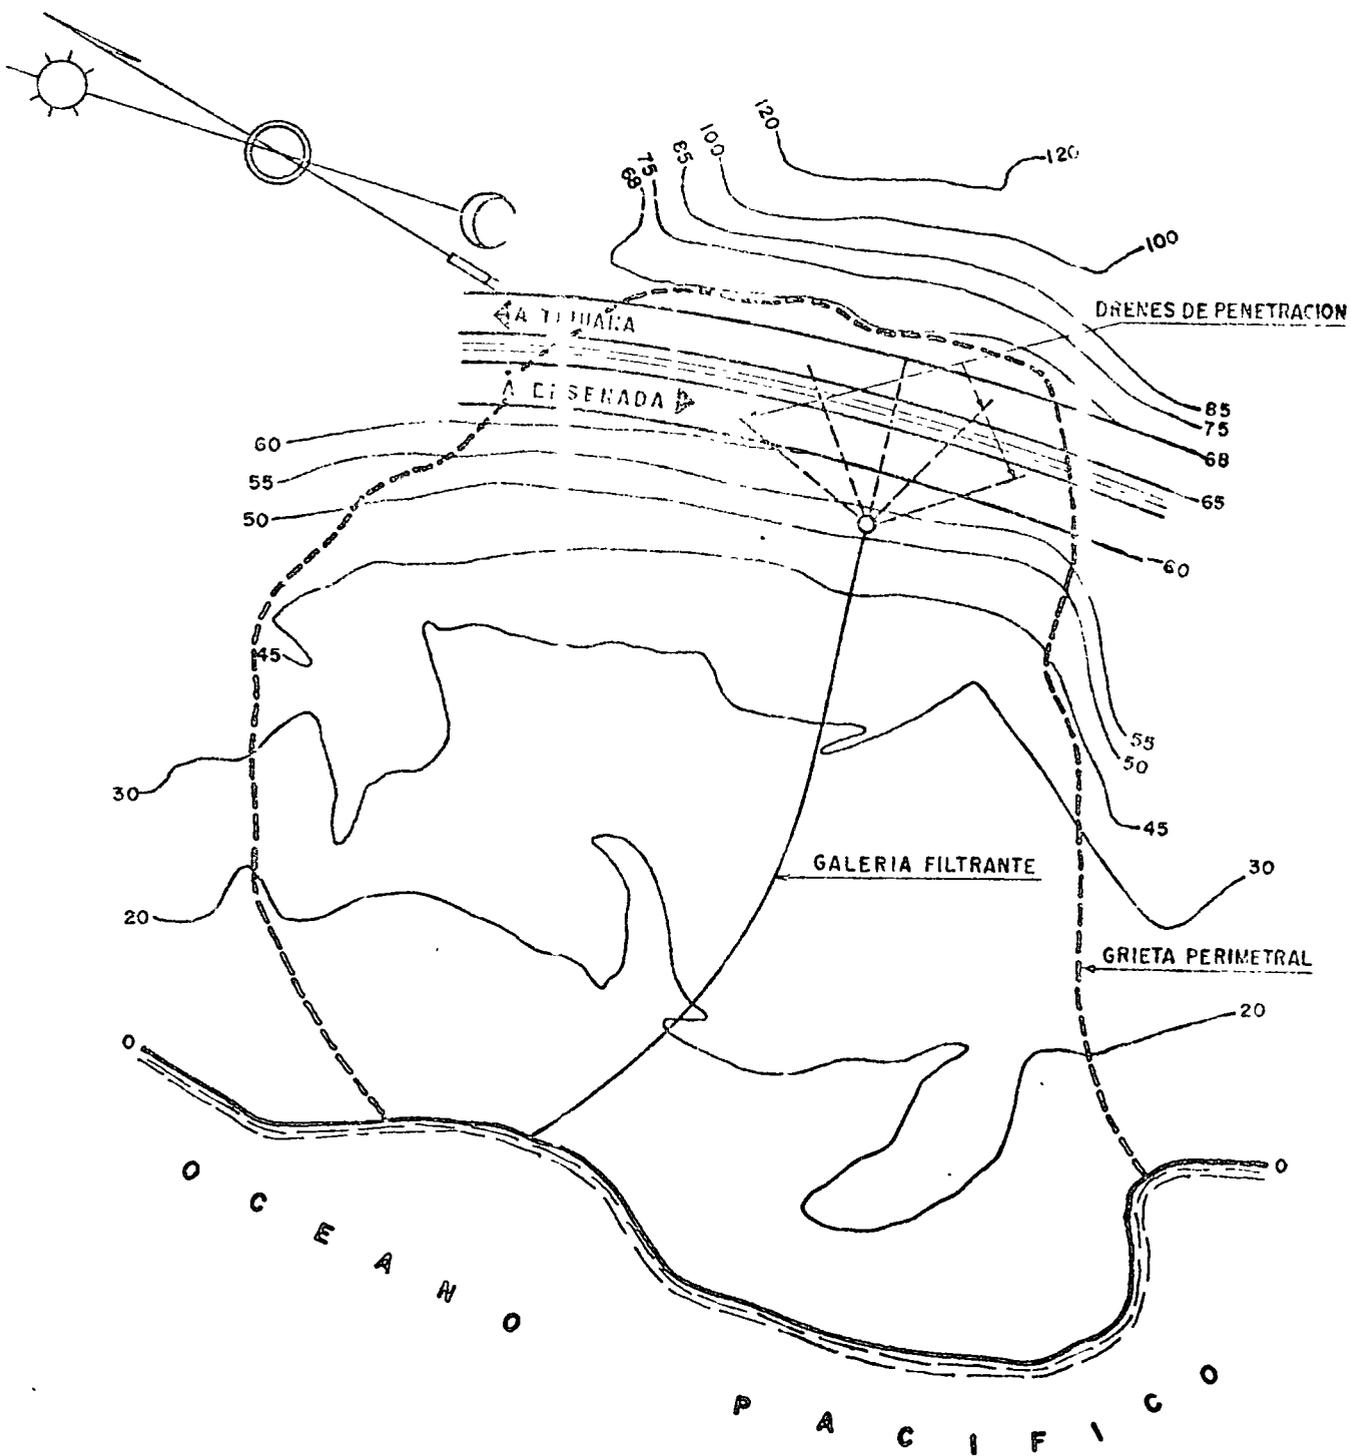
Planta de la galería filtrante del Km. 19+200 de la Autopista Tijuana - Ensenada.
